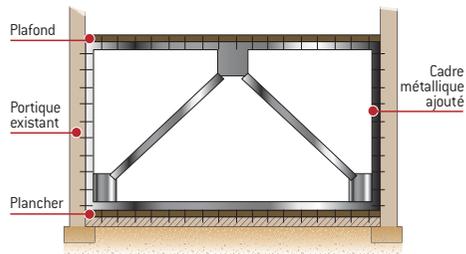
Exemple de renforcement du contreventement par ajout de croix type K ou Saint-André en charpente métallique ou en poutre de béton armé à un portique existant [coupe transversale]
